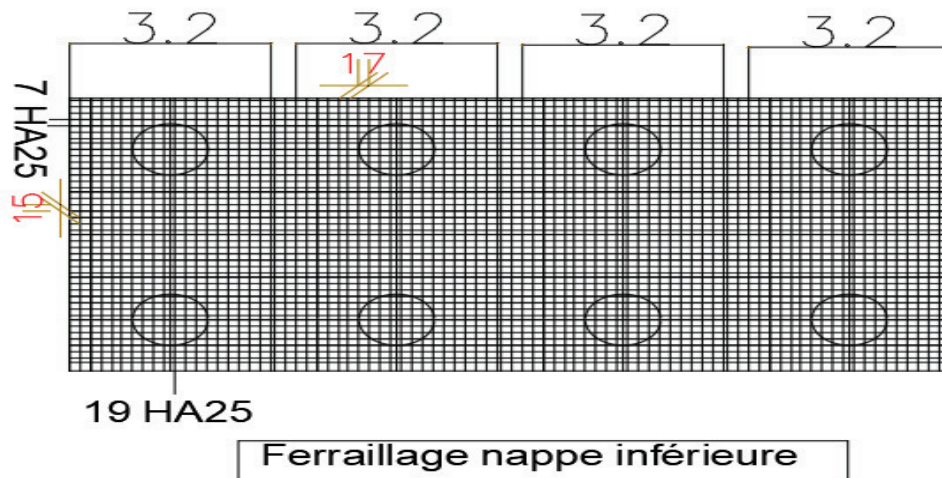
Ferrailage de la nappe inférieure de la semelle sous la pile
